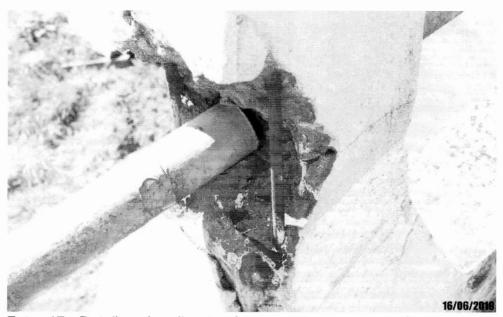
Detalhe do pilarete de concreto com armadura exposta, desplacamento de concreto e barra do guarda corpo soltando da estrutura.
